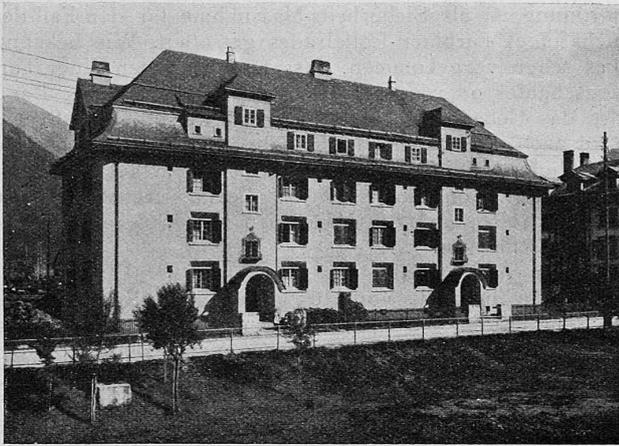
Strassenfront (N-W) eines Wohnhauses für 4x3 Familien der Rhät. Bahn in Samaden. — Abb. 2. Grundrisse dazu, 1:400.
